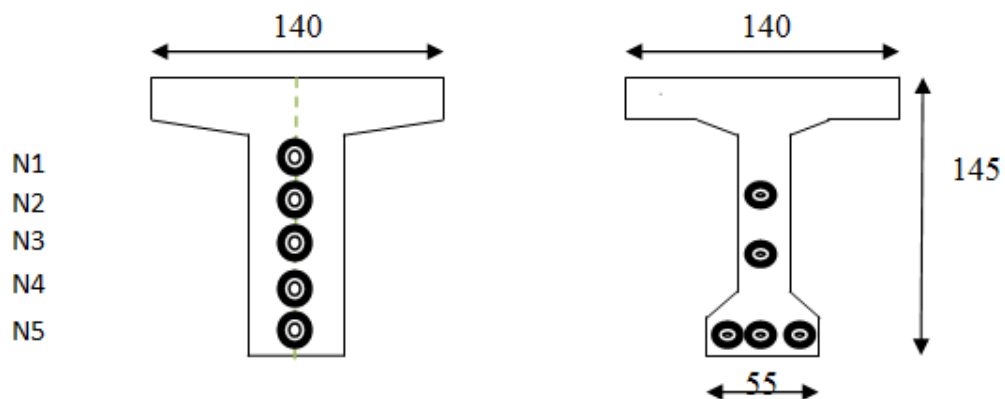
L'emplacement des câbles dans les sections de poutres 'About et mis travée' (coupe transversale)
